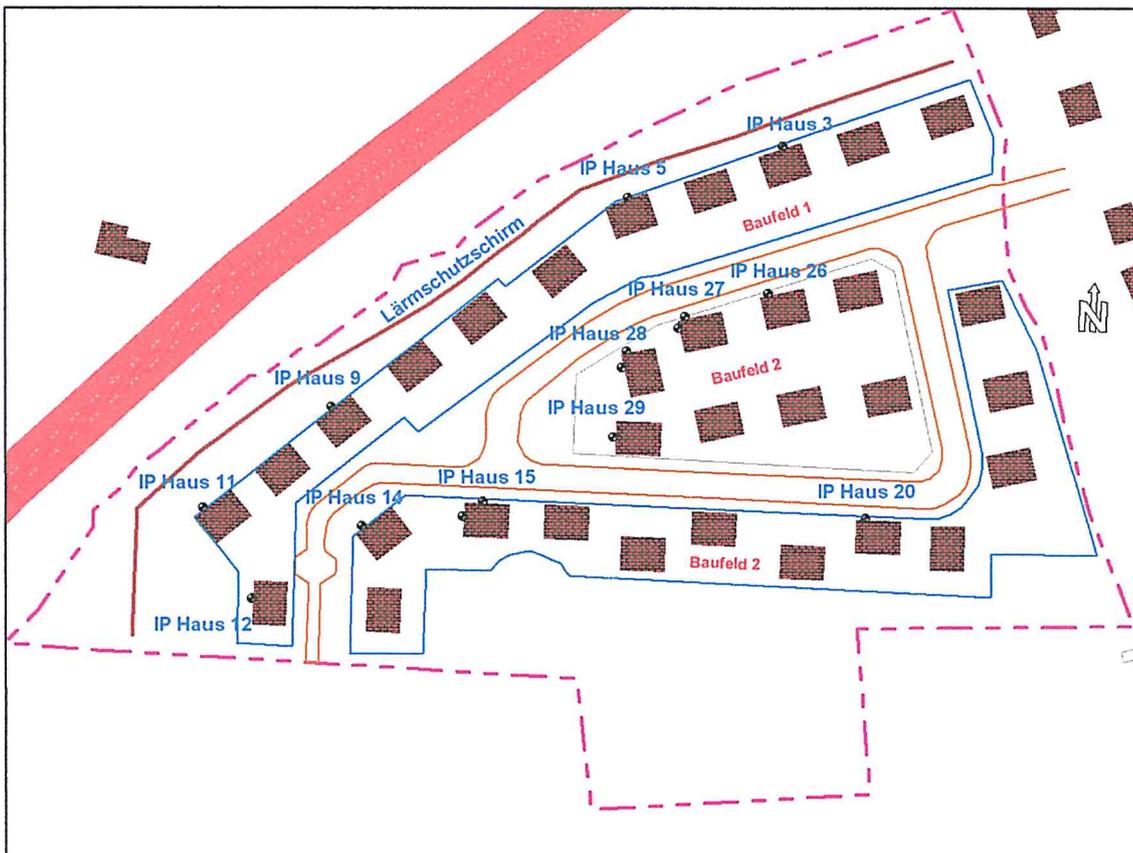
Lageplan des B-Plangebietes entsprechend dem Vorentwurf vom 07.12.2016 zum B-Plan Nr. 43
